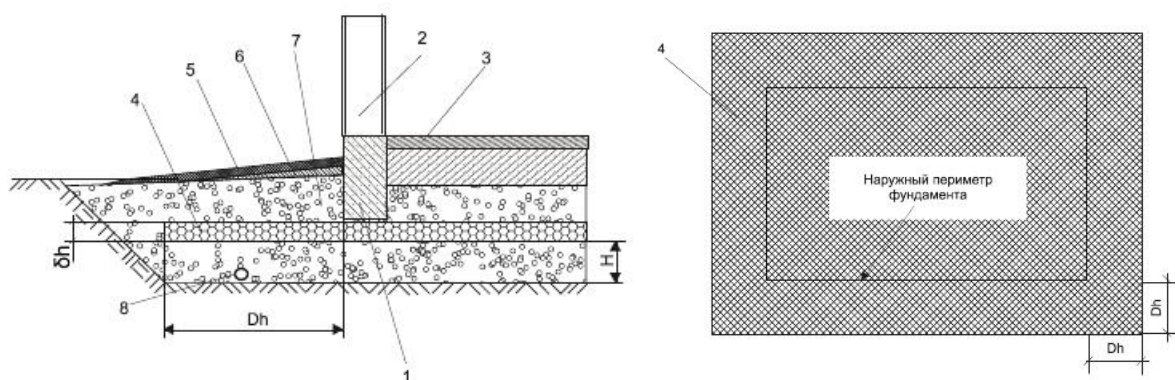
Схема укладки и параметры теплоизоляции в фундаментах неотапливаемых зданий: 1-фундамент; 2-стена здания; 3-пол здания; 4-горизонтальная теплоизоляция; 5-асфальтовая отмостка; 6-песчаная подготовка под отмостку; 7-непучинистый грунт; 8-дренаж
